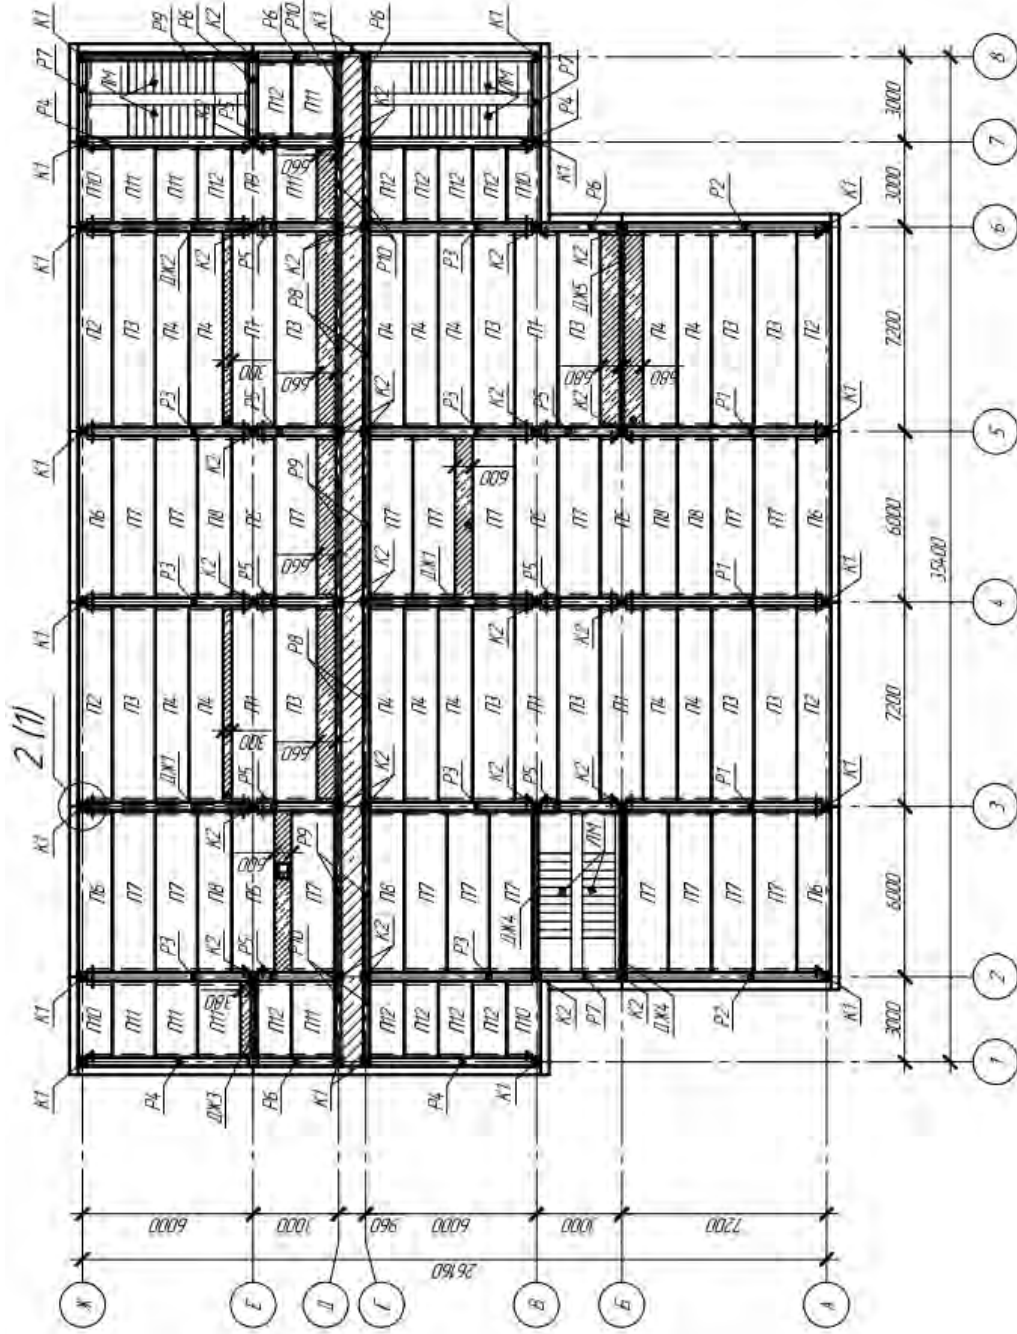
Пример выполнения схемы расположения элементов перекрытия
